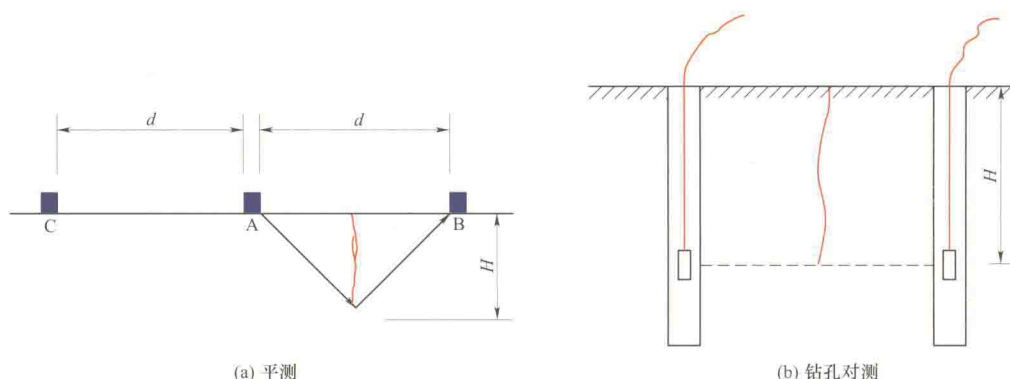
超声波检测混凝土裂缝深度示意图
